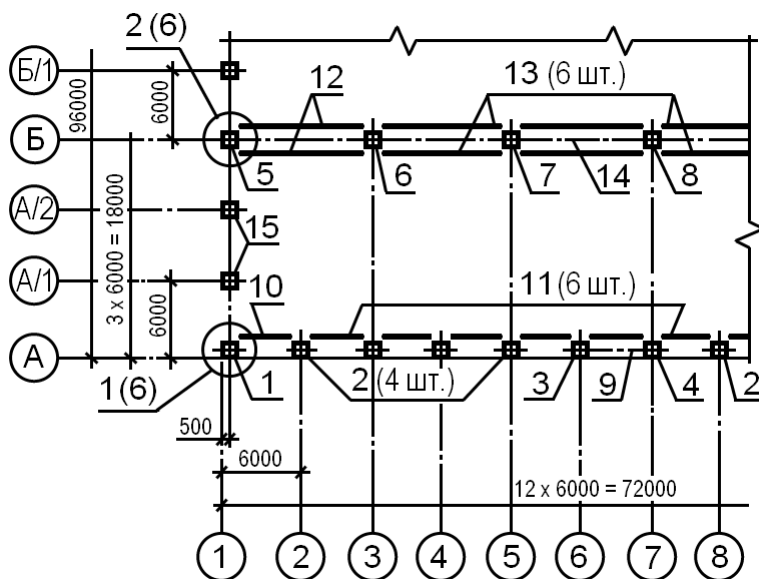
Схема расположения колонн и подкрановых балок
